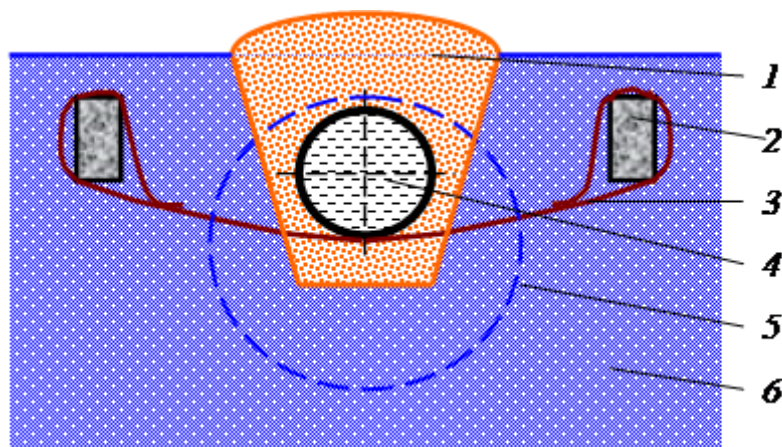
Схема укладки подземного трубопровода на гибкие опоры 1 – траншея; 2 – анкерный бетонный блок; 3 – нейлоновый ремень; 4 – трубопровод; 5 – ореол протавивания грунта; 6 – вечномерзлый грунт
